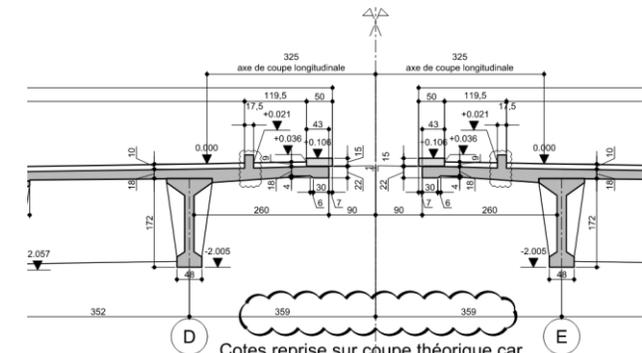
Coupe transversale type du hourdis supérieur avec tracé du câble - Extrait du plan « 63 - 14.922 G - Superstructure des 3 travées centrales - Dalles & Ames - Câblage & armatures »
